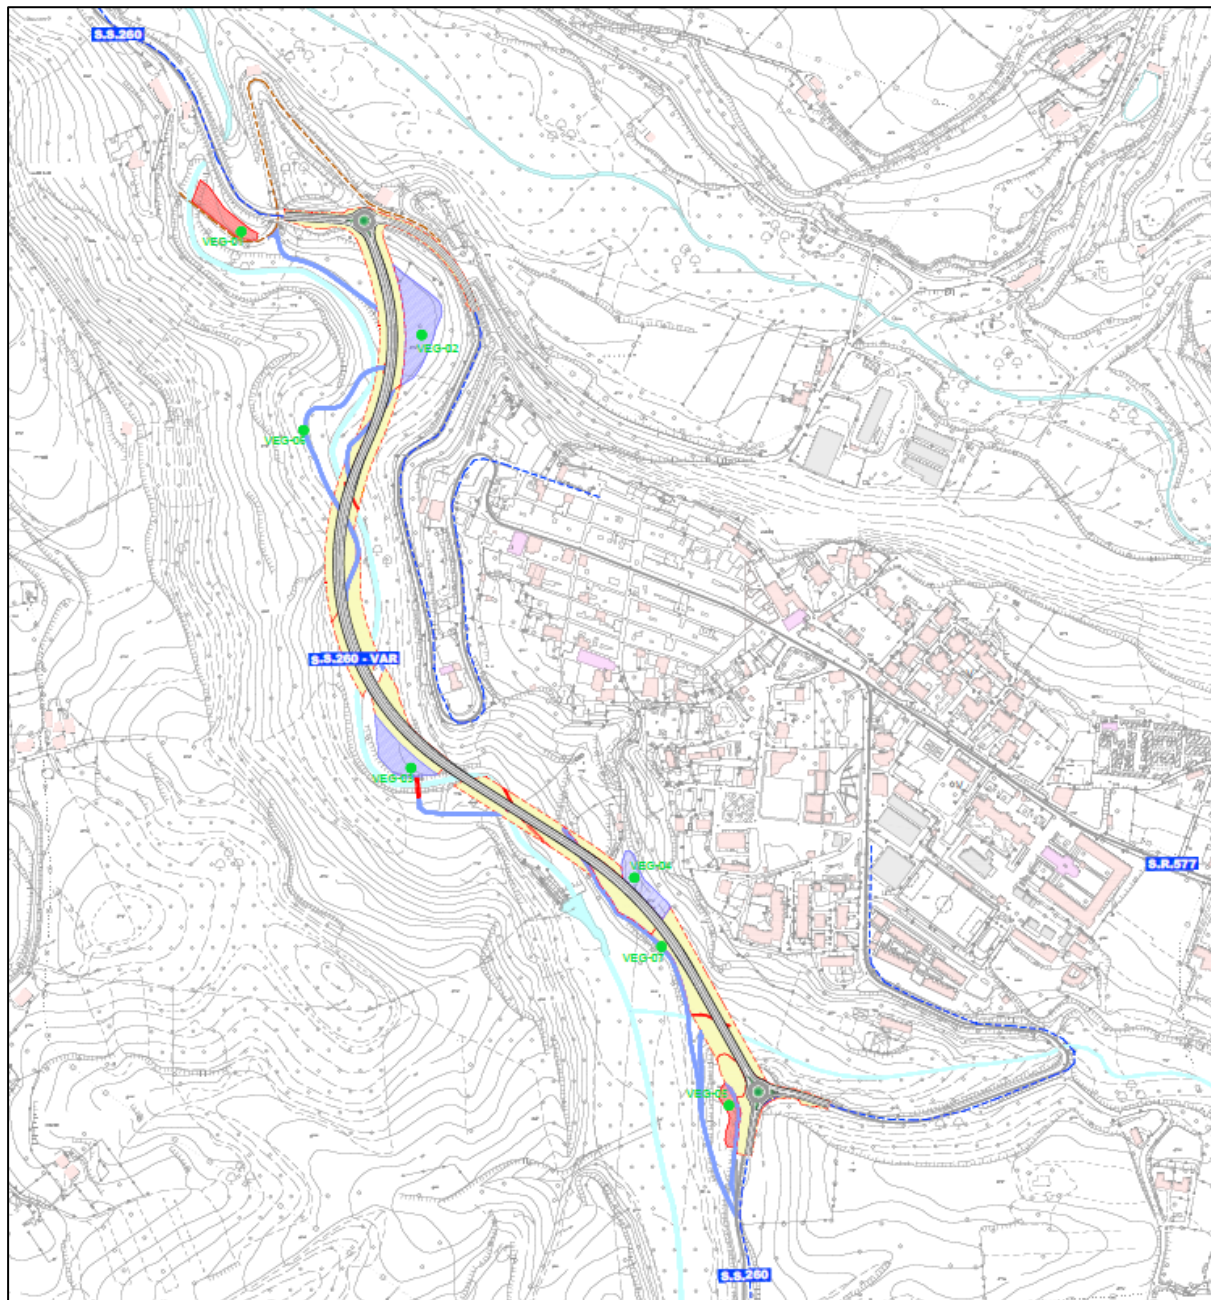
Planimetria punti di monitoraggio componente Vegetazione
